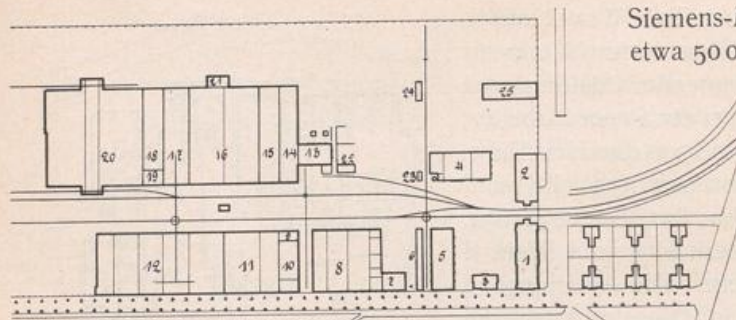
Maschinen-Bauanstalt Hohenzollern, Aktiengesellschaft. Lageplan.
